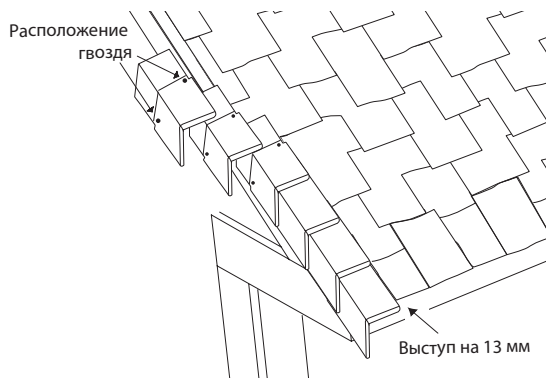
Укладка гонта Mountain Ridge на край ската.
